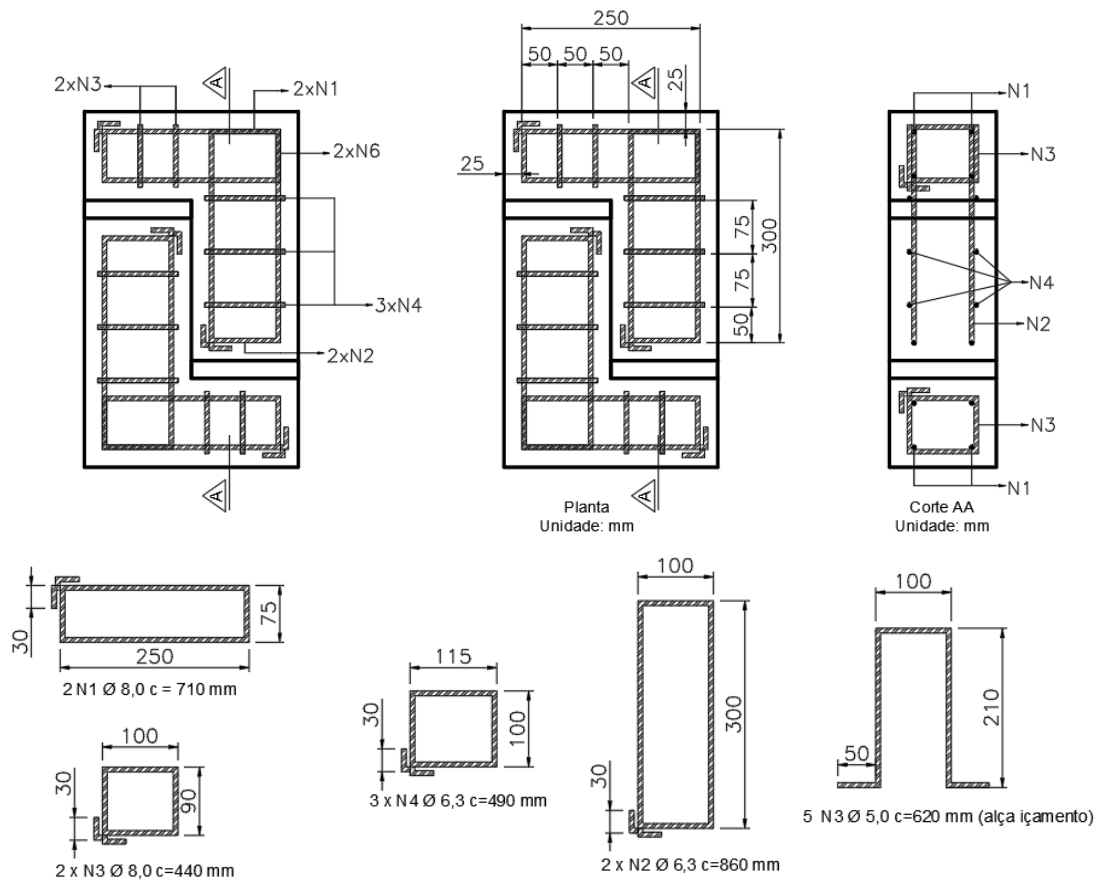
Detalhamento da armadura usada nos corpos de prova
